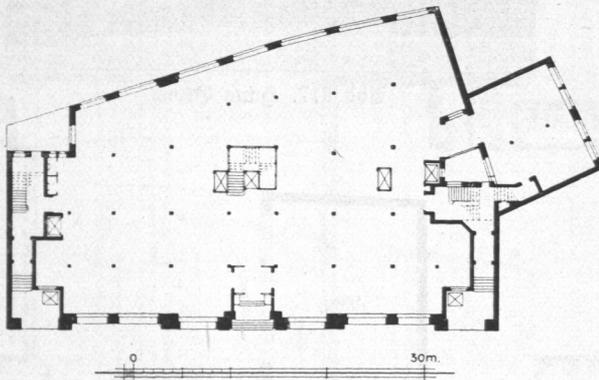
Geschäftshaus Wm. Klöpffer, Grundriß.
